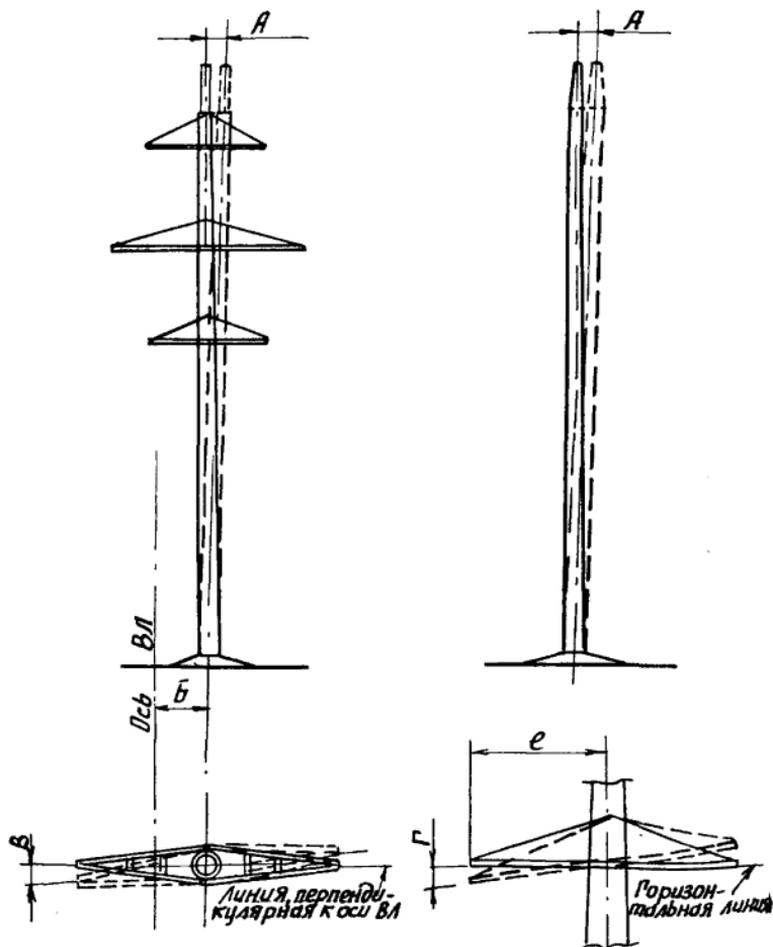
Нормы и допуски на установку одностоечных железобетонных опор
